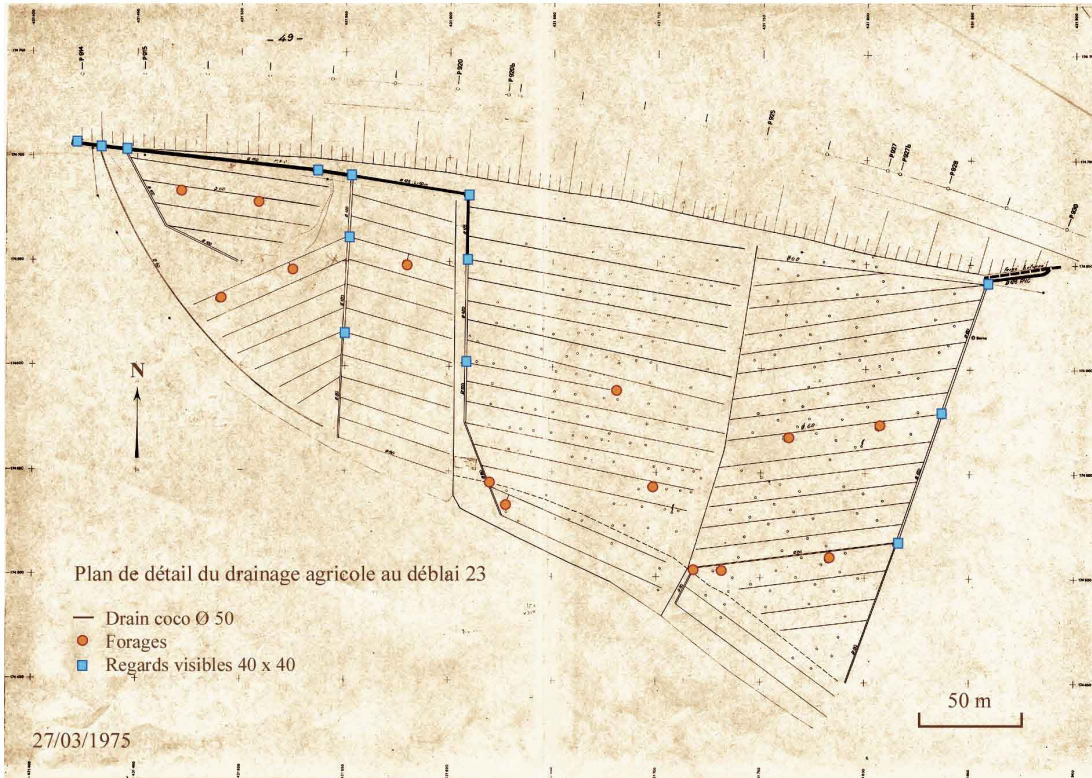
Drainage par tranchées (A 13 Dozulé) - Vue en plan.
